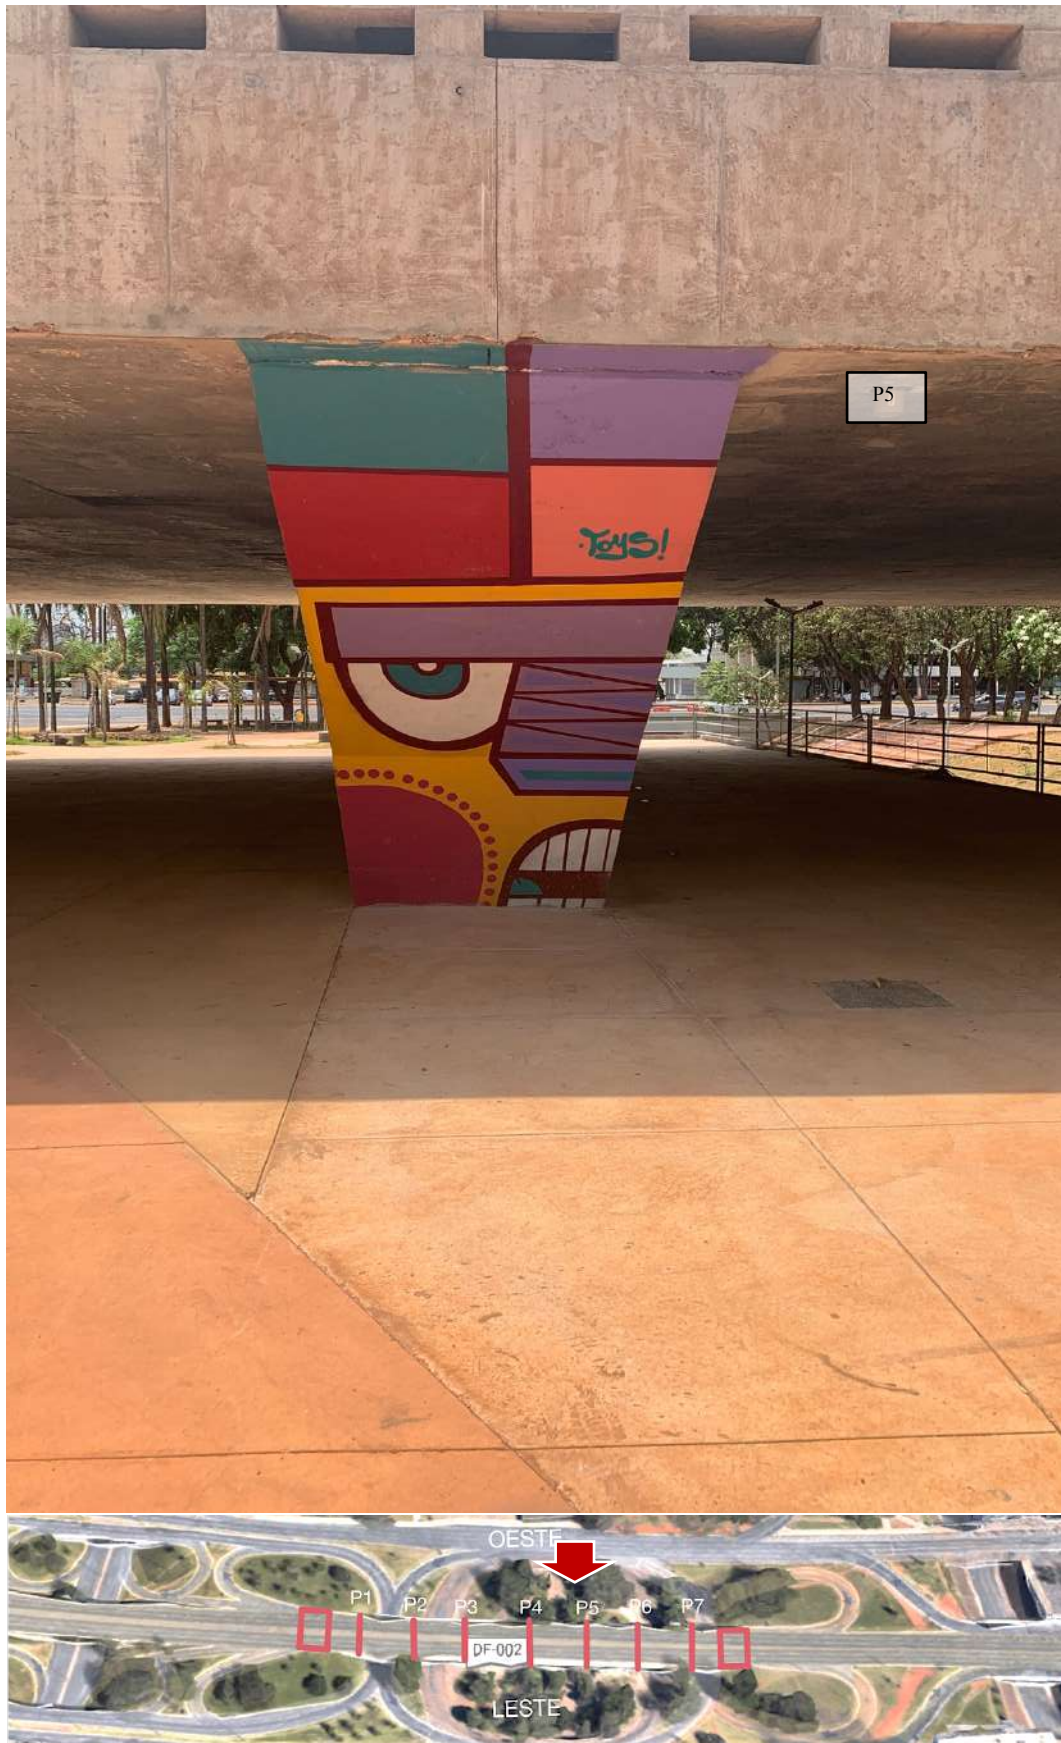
Pilar 5, Lado Oeste, vista frontal. Fonte: autoral / Adaptado de Google Earth
